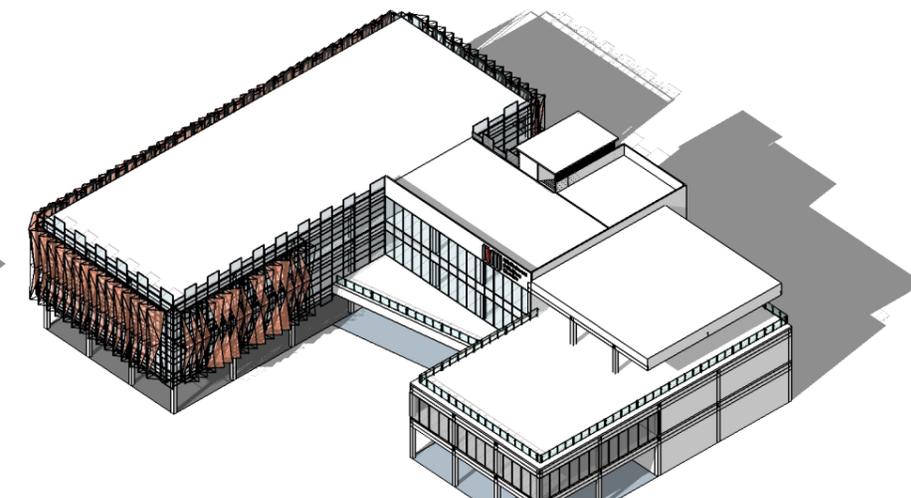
Armado de doble fachada (chapa perforada) a columnas y losa
